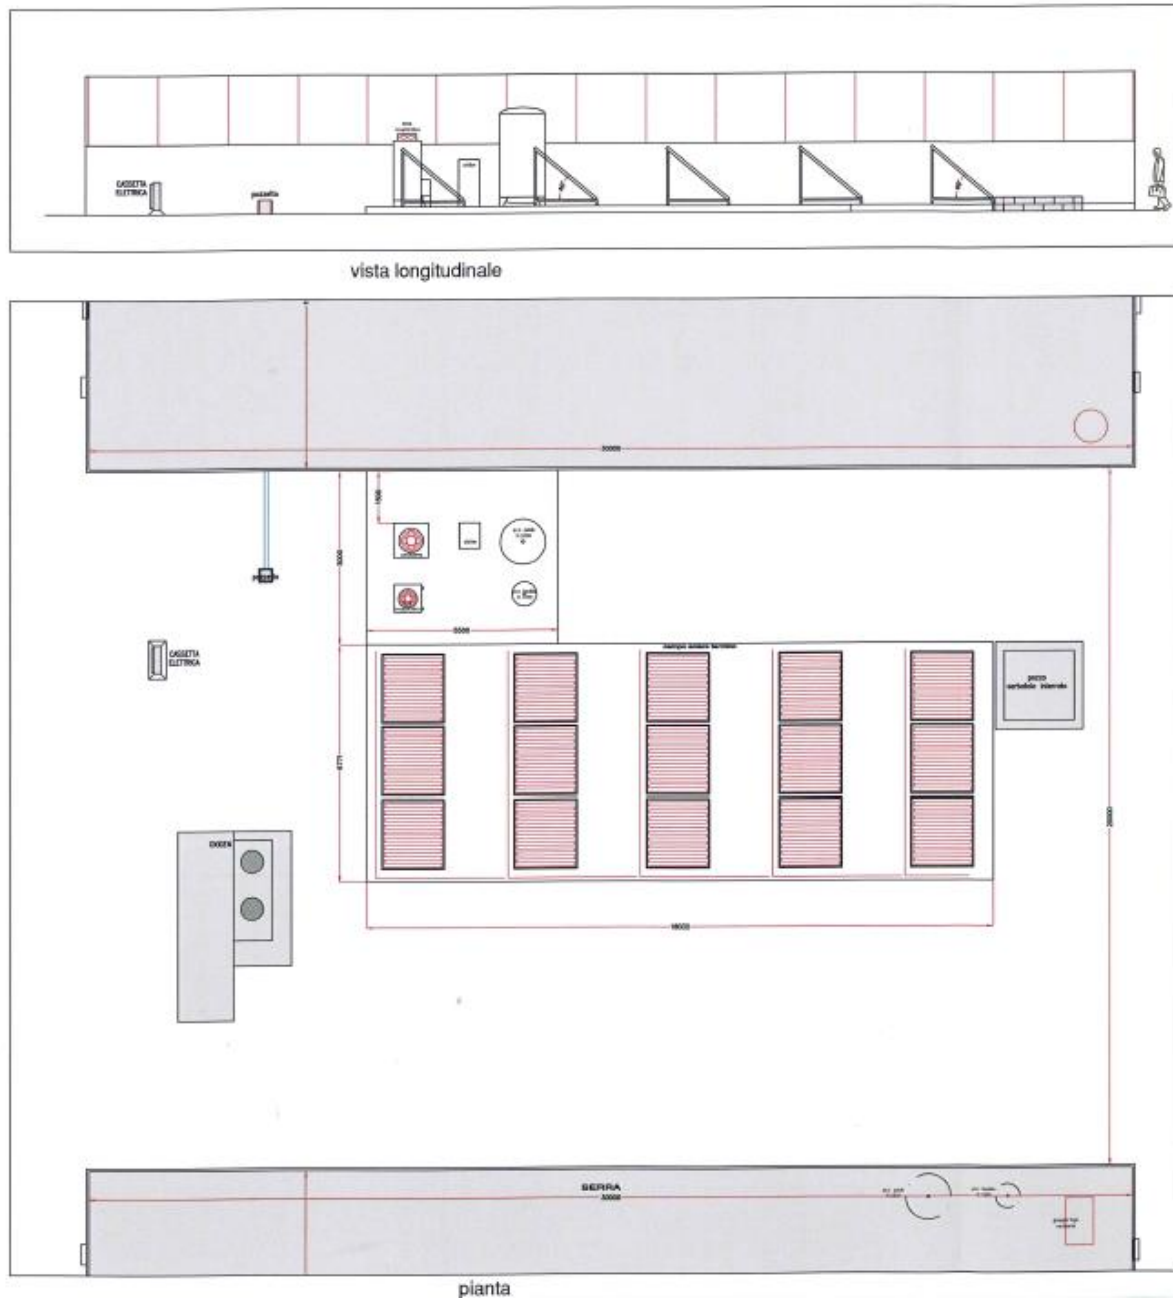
(A): Layout dell'impianto di solar cooling presso l'Università di Bari.
